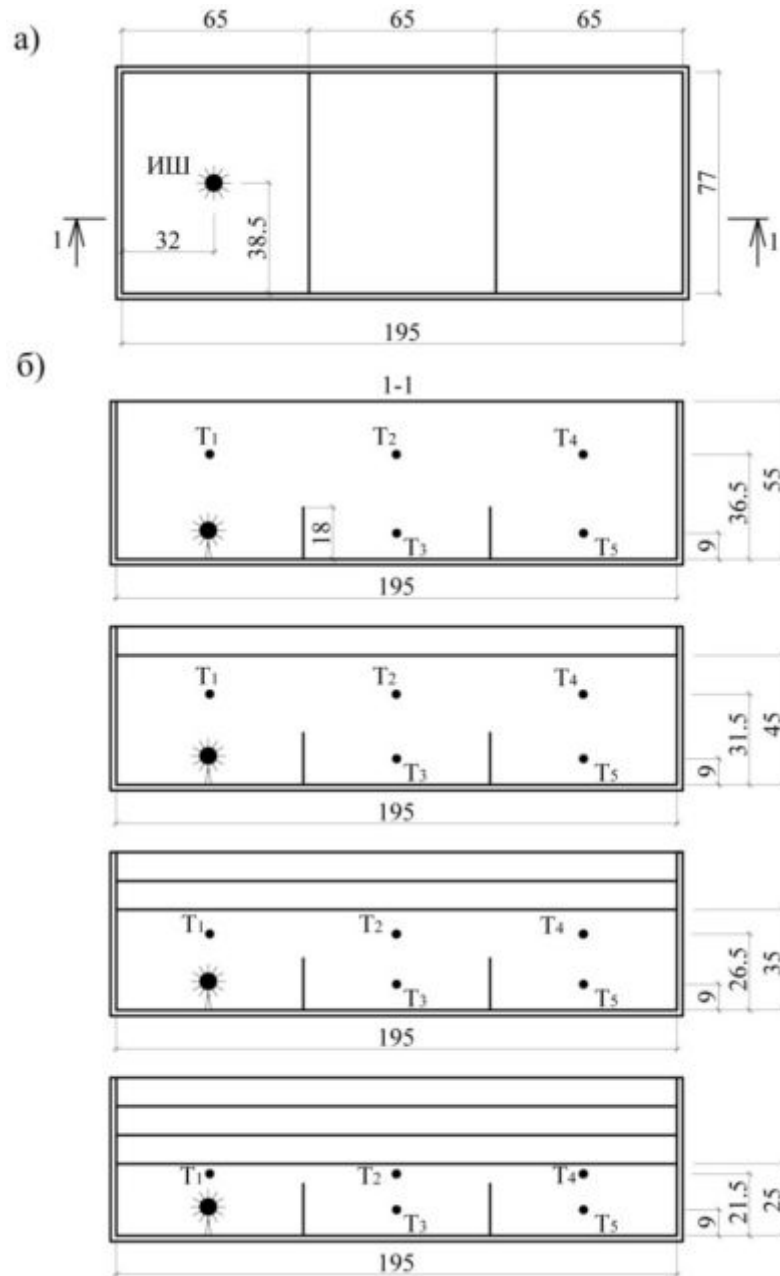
Схема модели помещения с указанием положения перегородок и расчетных точек: а) - план модели; б) - сечение 1-1.
